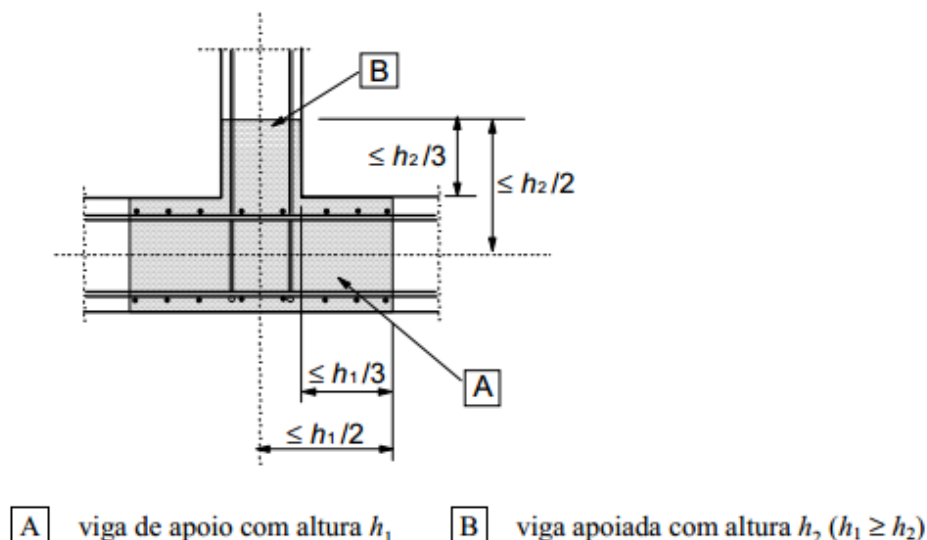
Colocação de armadura de suspensão na zona de intersecção de duas vigas
